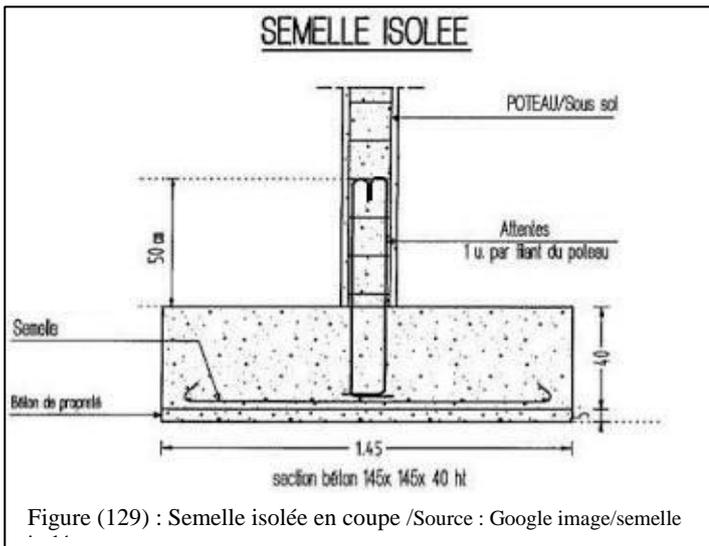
Semelle isolée en coupe /Source : Google image/semelle
